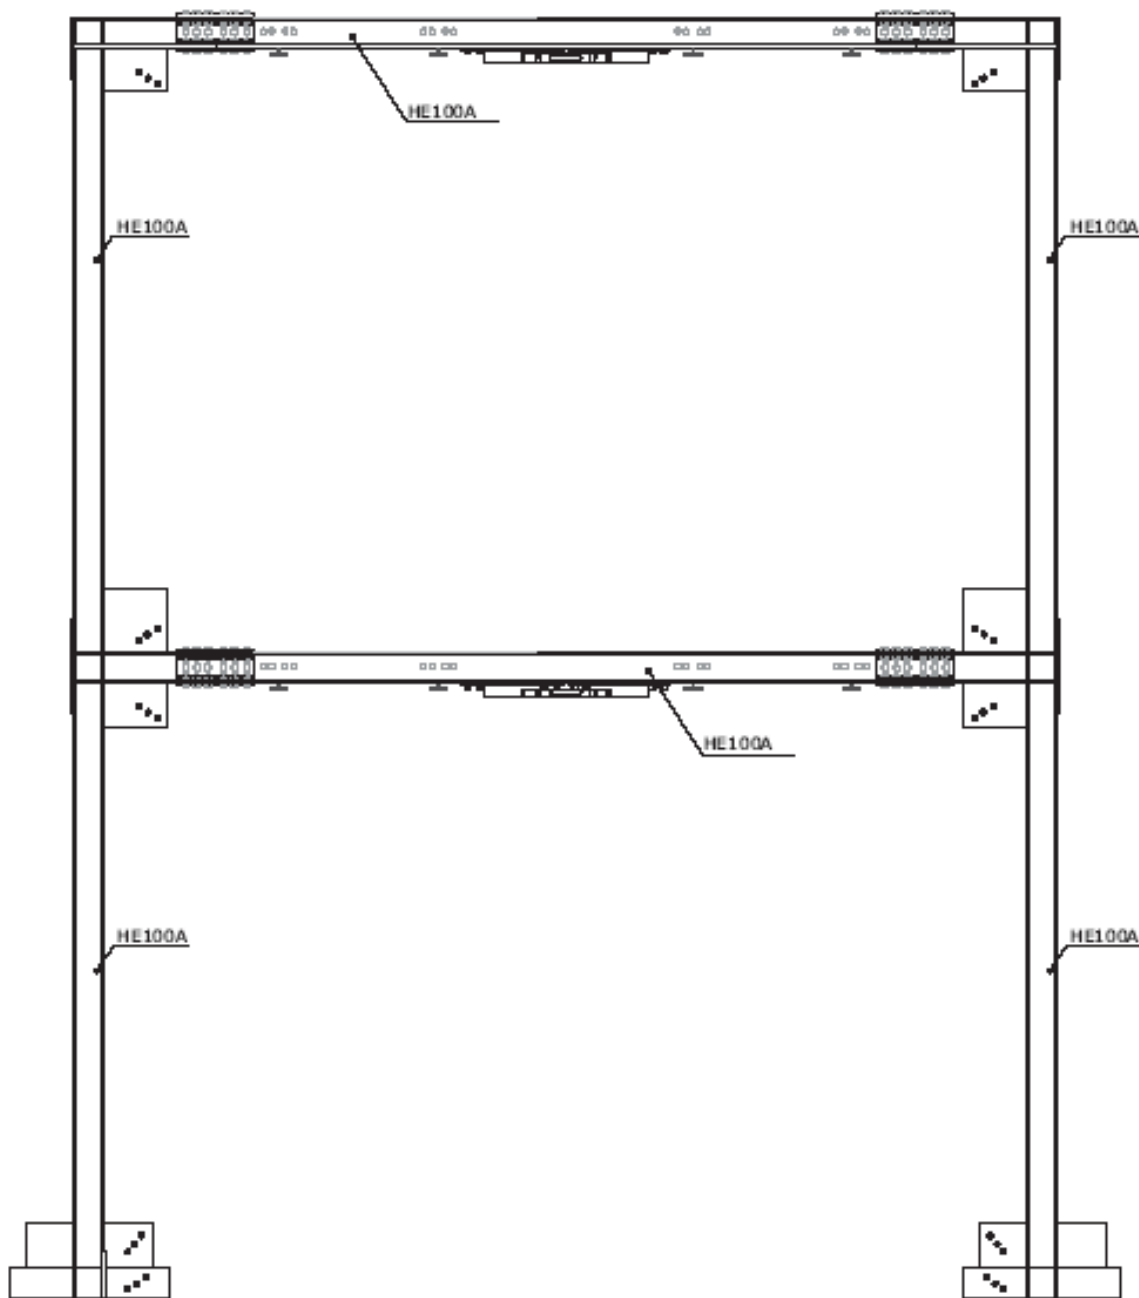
Prospetto del telaio (il lato rappresentato è quello corrispondente alla dimensione in pianta di 3m)
